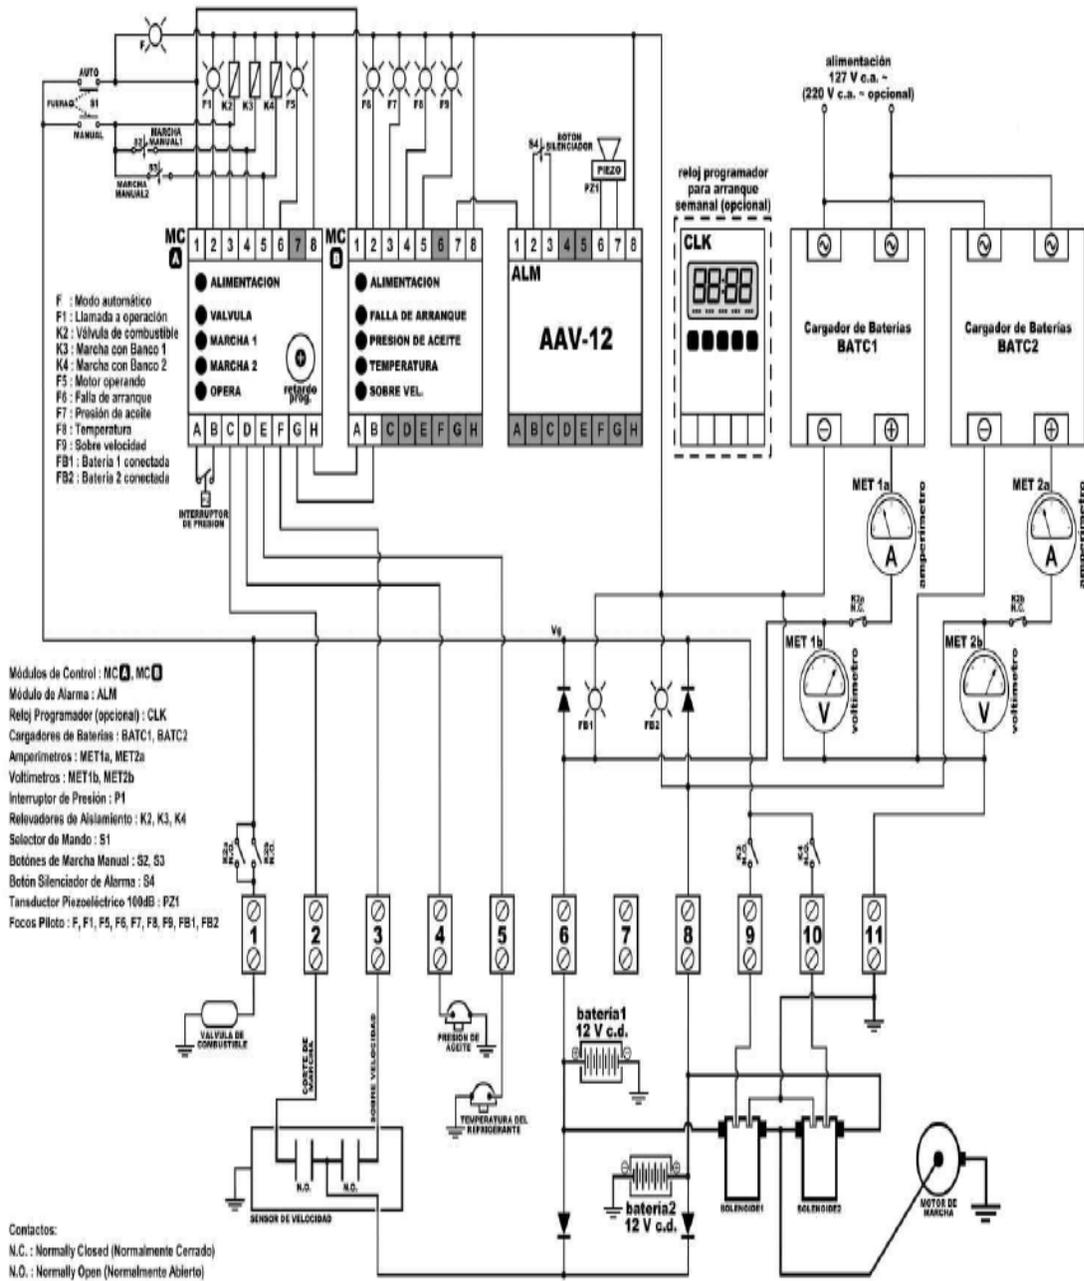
Tableros de control para bomba acoplada a motor Diesel
